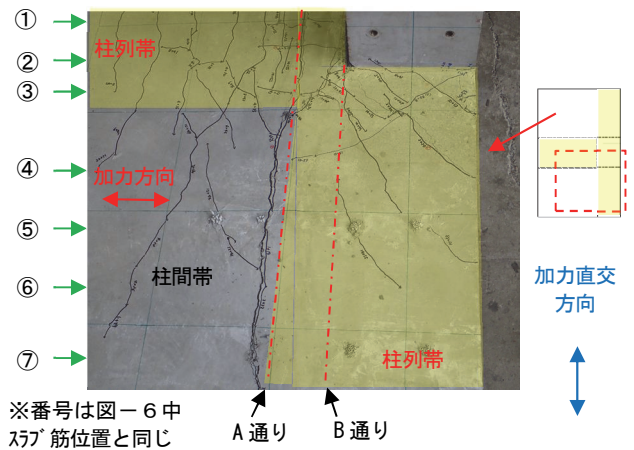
ひび割れ状況とスラブ筋位置 (No.4)
